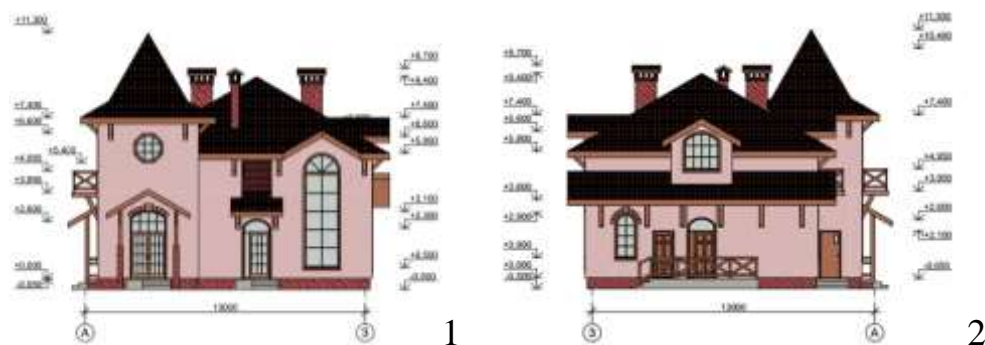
1. Фасад А-3; 2. Фасад 3-А
